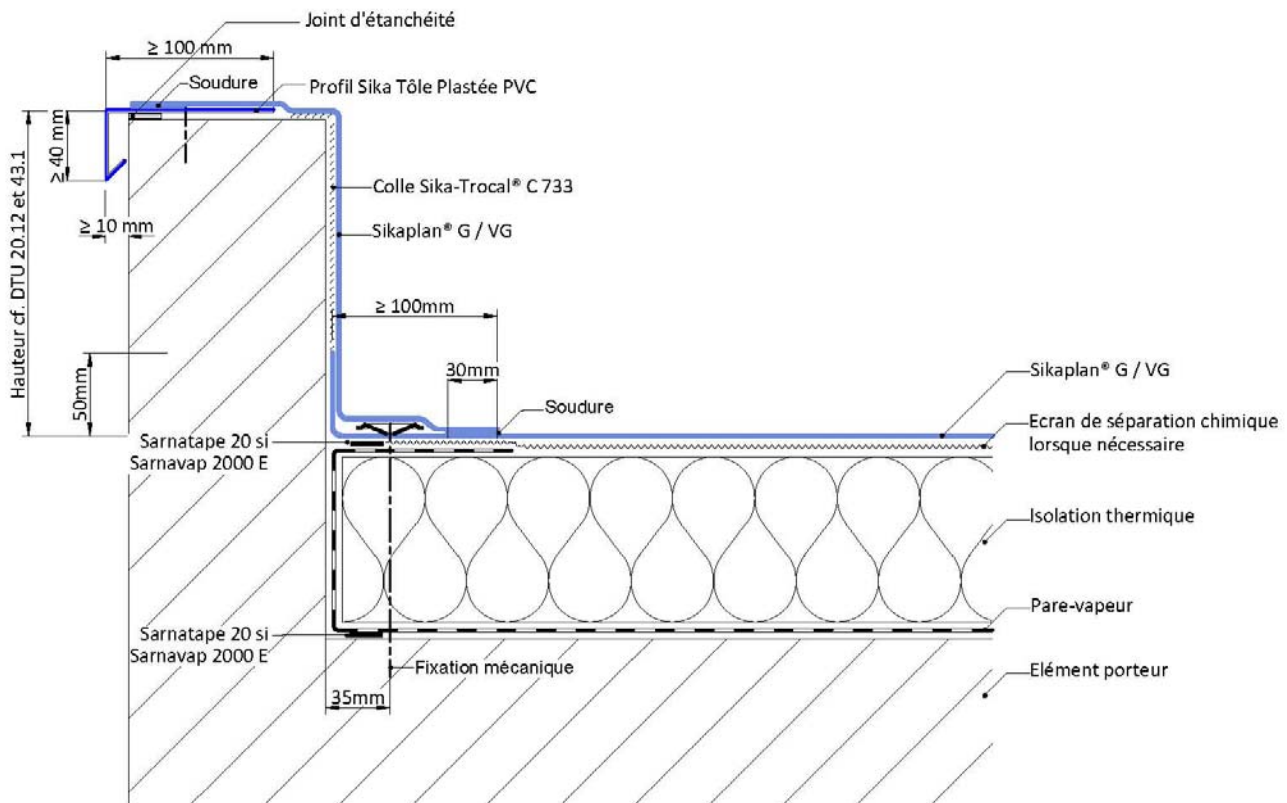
Relevé d'étanchéité avec profil en tôle plastée - Travaux neufs sur maçonnerie
